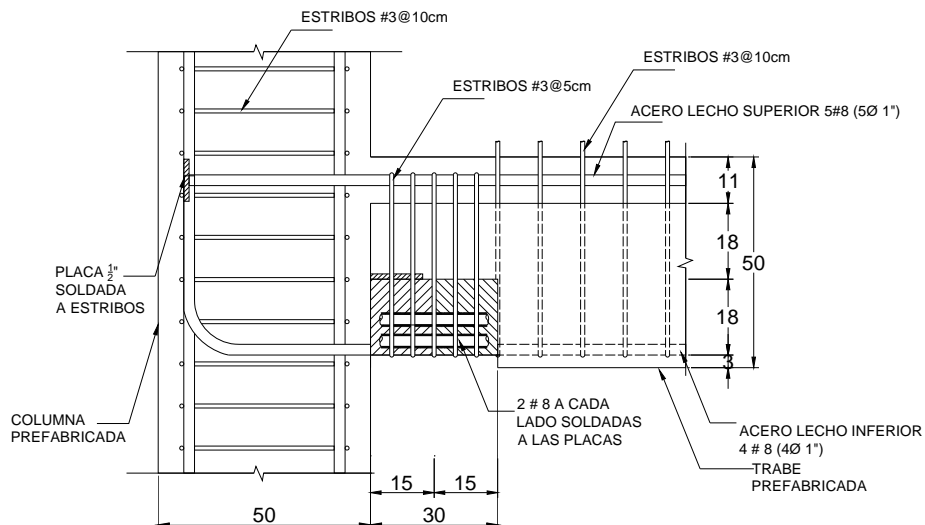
Detalles en espécimen típico que representa a una conexión trabe-columna con varillas soldadas a placas (Zermeño *et al.*, 1992)
